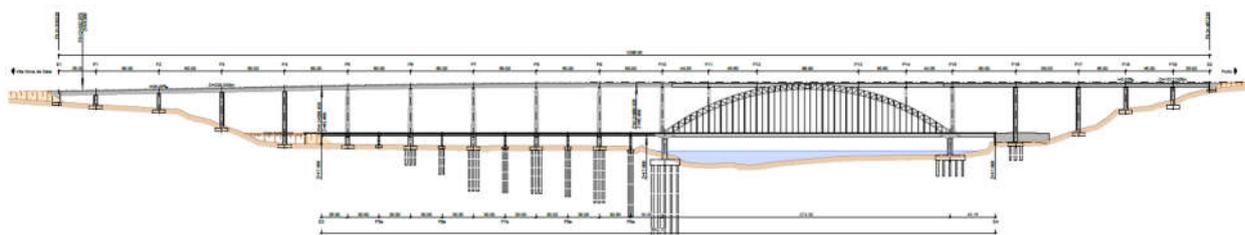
Alçado geral da estrutura – Ponte do Douro
